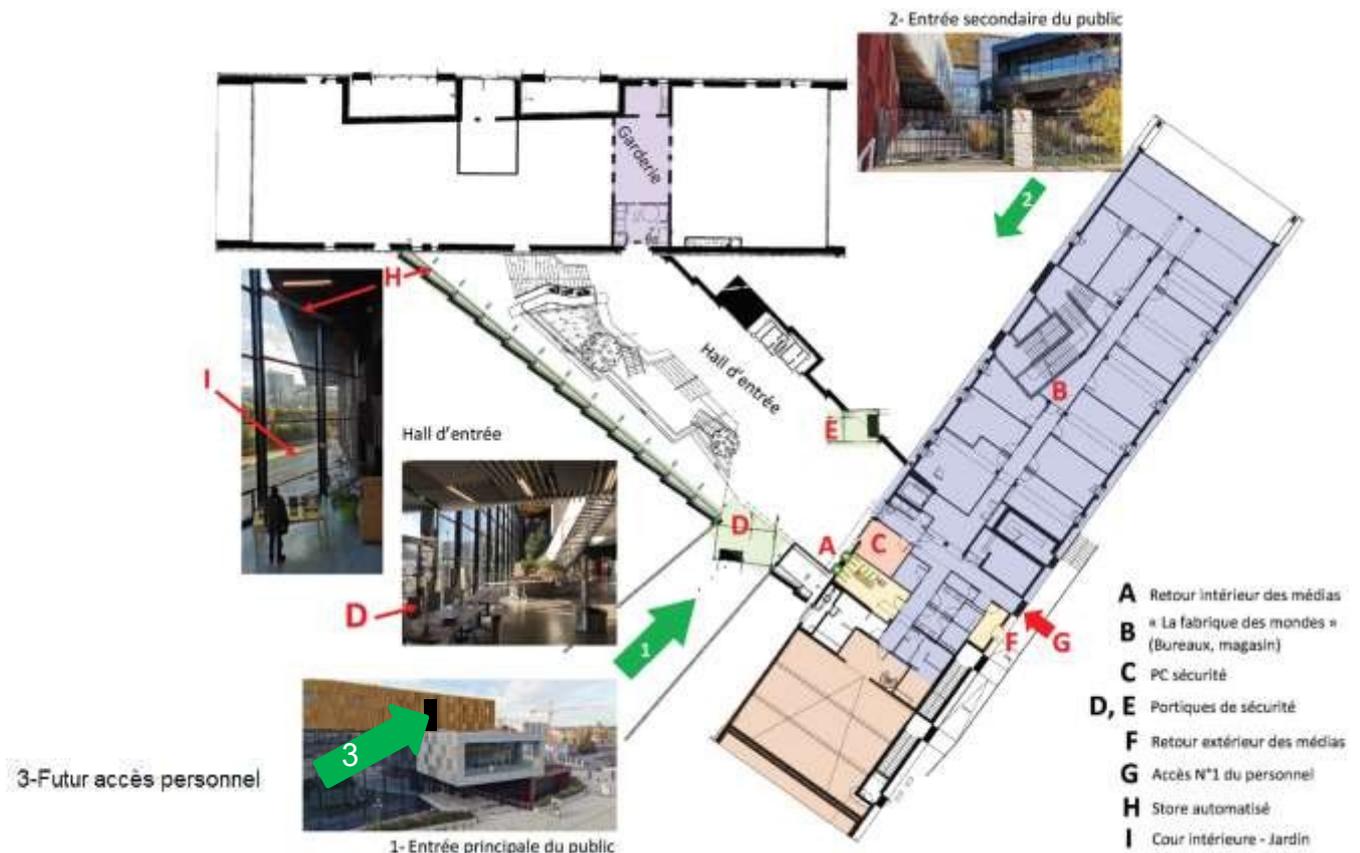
plan du niveau 0 - rez-de-chaussée de l'ALPHA
